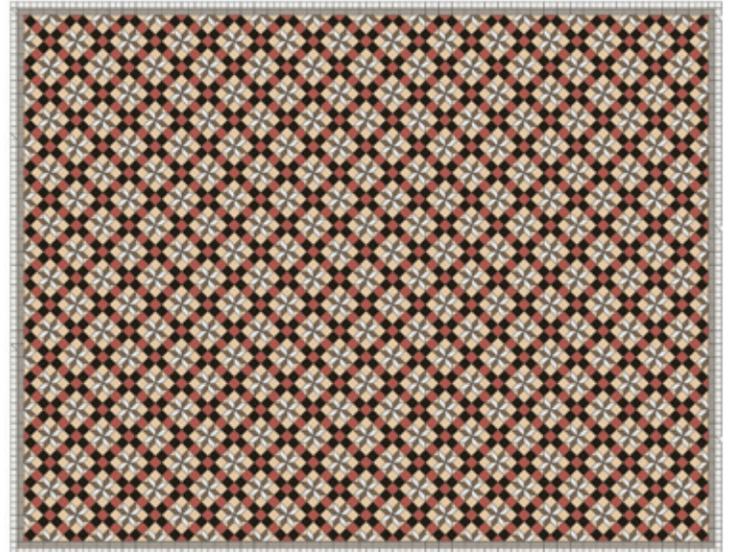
Villa Morris. Pavimento de cerámica Nolla del dormitorio principal, en la primera planta. Fuente: Autores.
